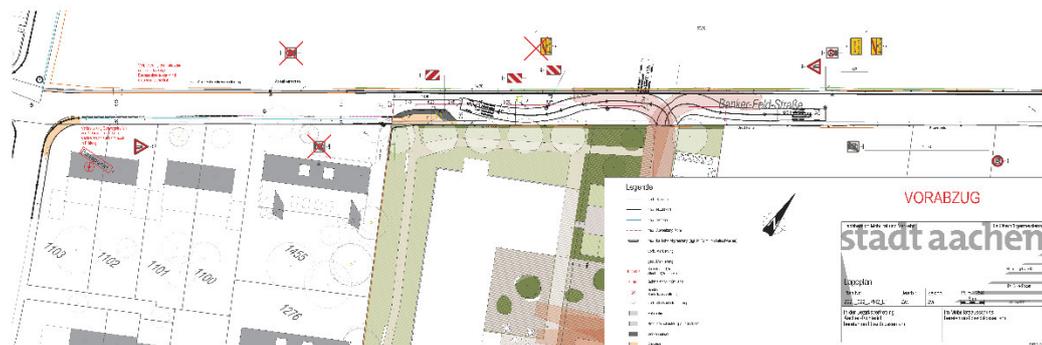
Planung Banker-Feld-Straße (Lageplan Vorabzug, Stand April 2024) Stadt Aachen
